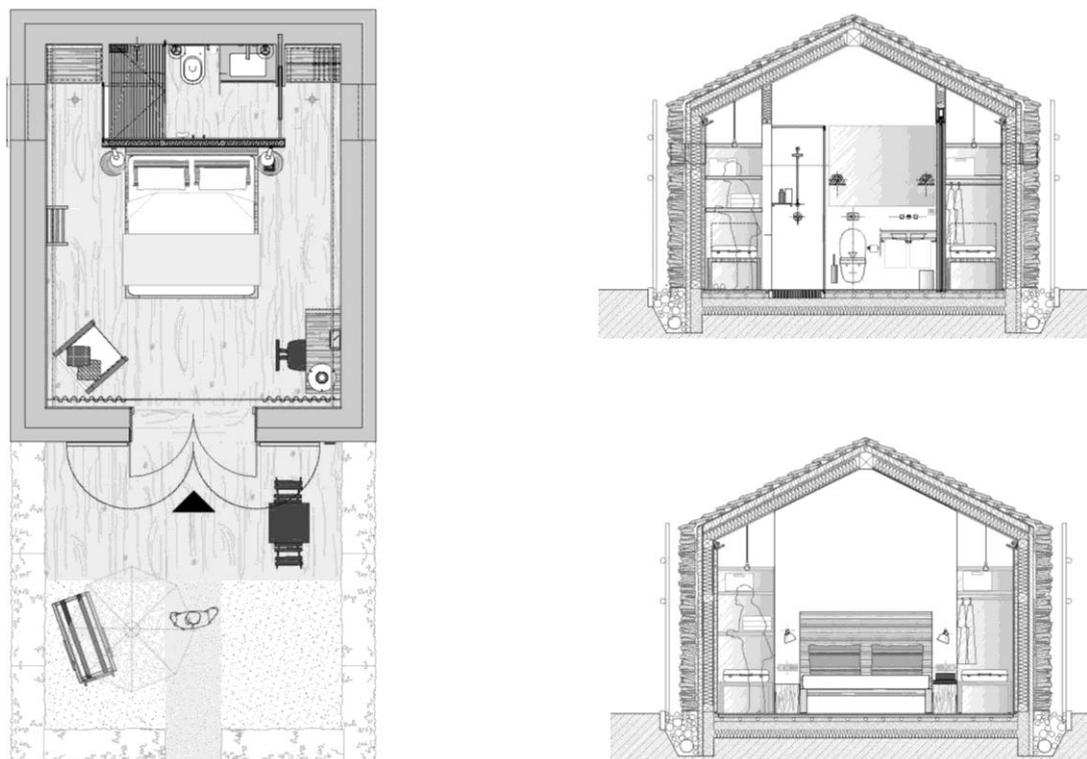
Grundriss und Schnitte Winterhäuschen
